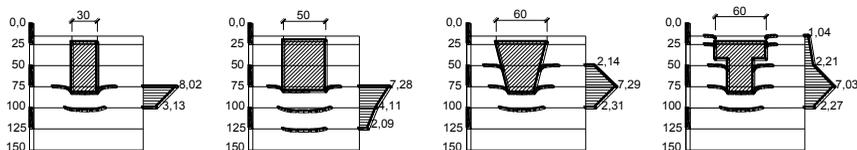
Деформации грунта основания при работе моделей фундаментов
